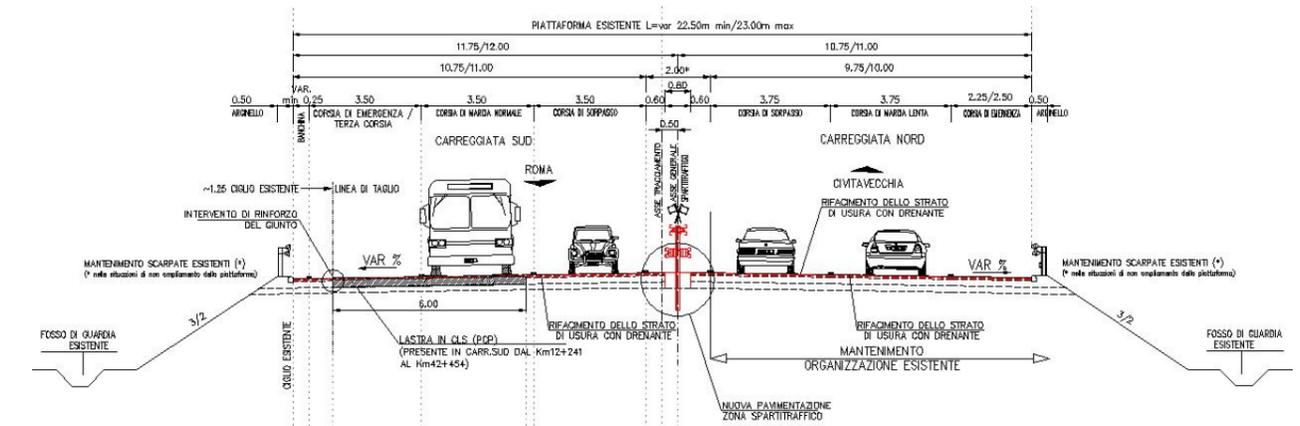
Sezione tipo piattaforma di progetto Autostrada A12
